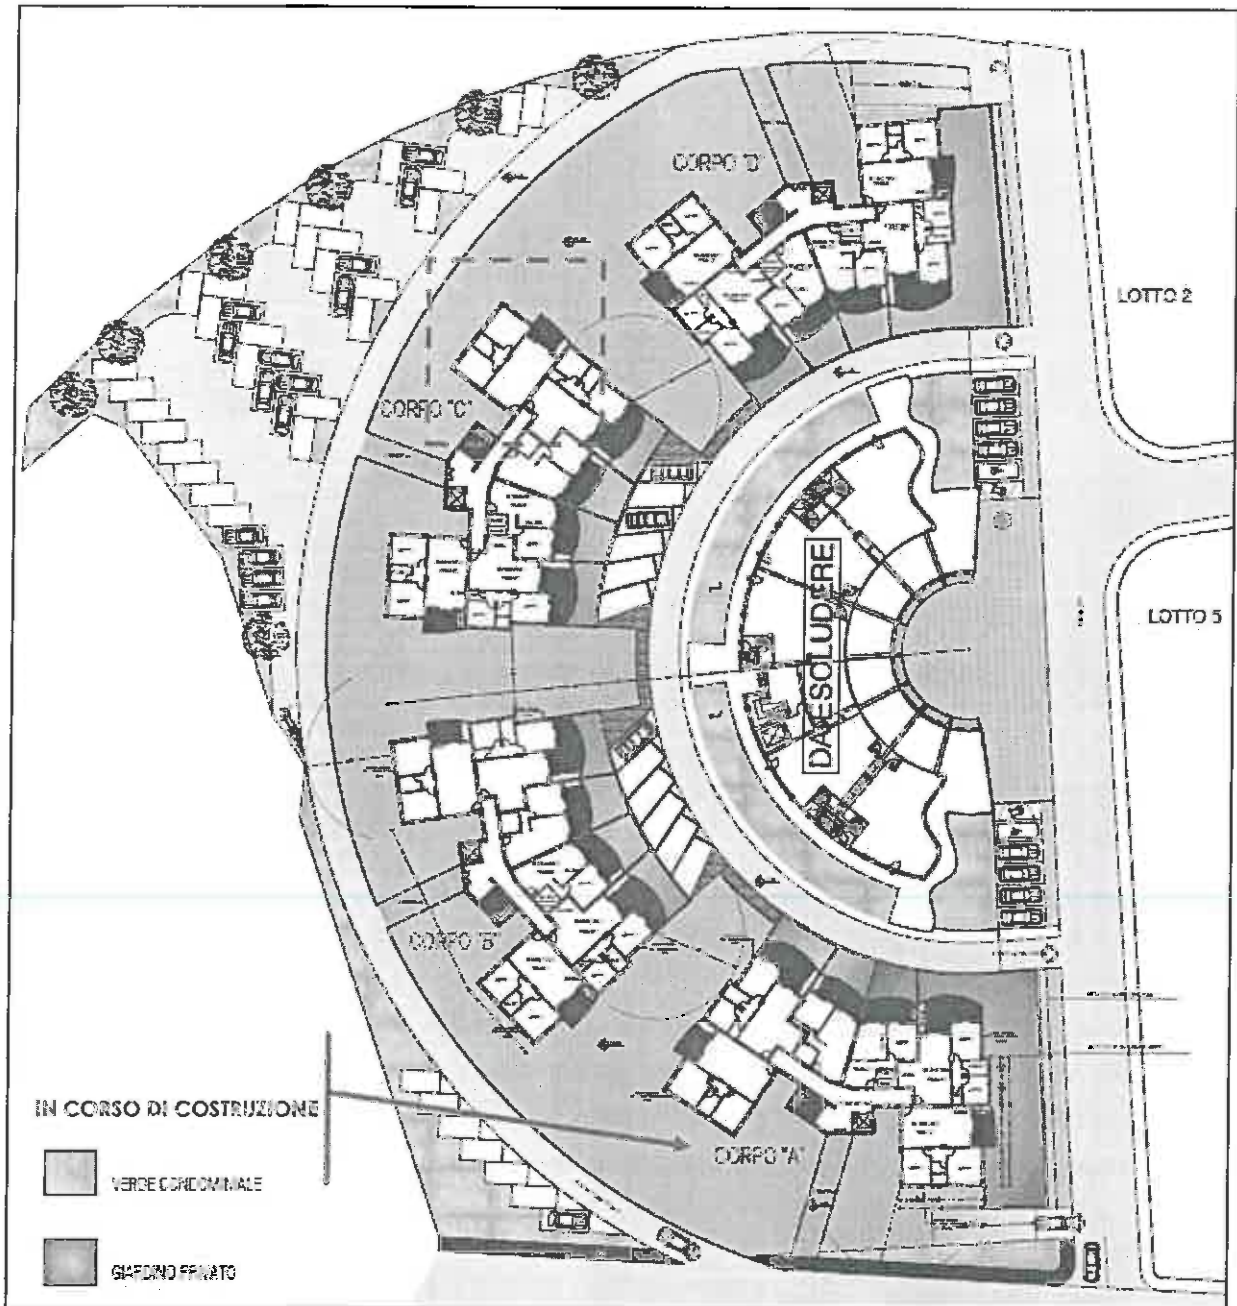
Schematizzazione Lotto 1 - Stralcio Tavola A\_02
